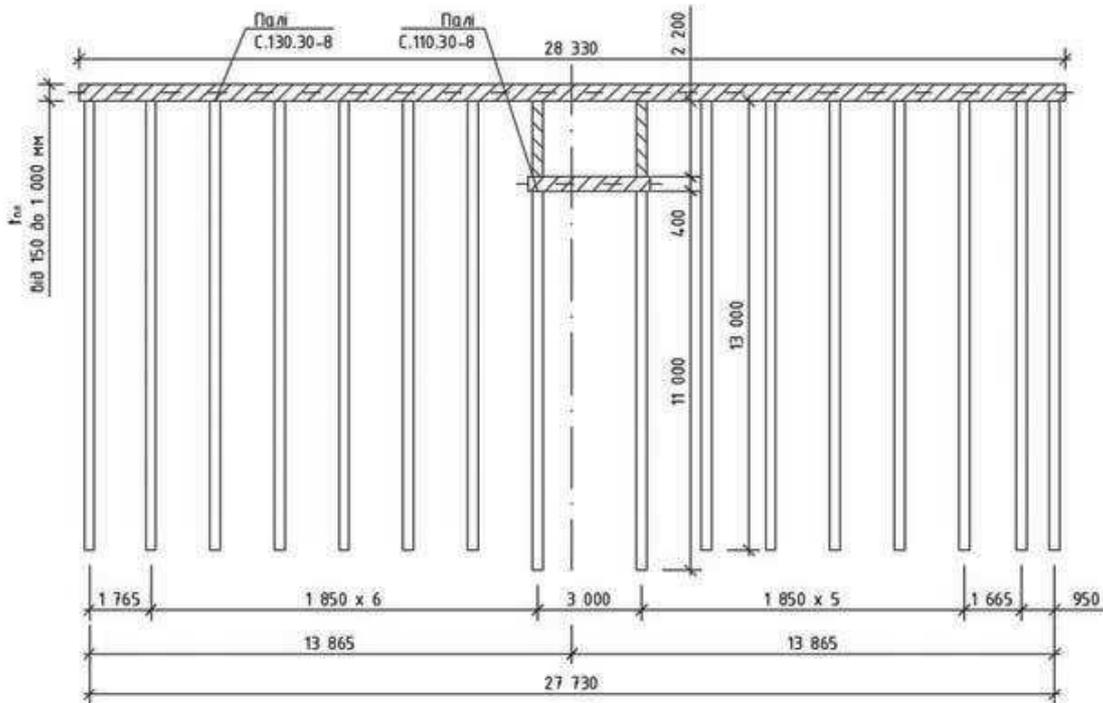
Поперечний розріз фундаменту з кроком палей 5D-6D
